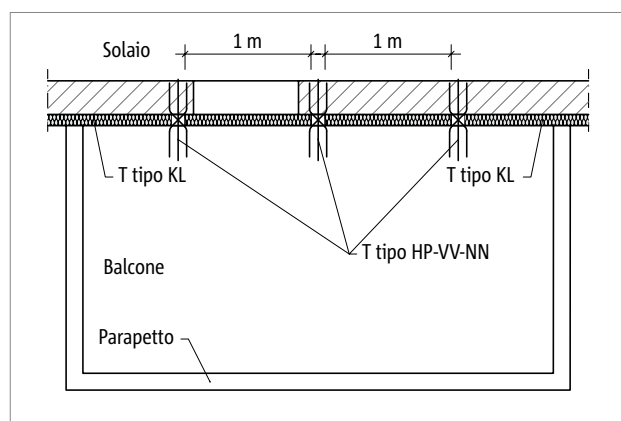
Disposizione di Schöck Isokorb® T tipo KL e tipo HP-VV-NN (variante 2)
